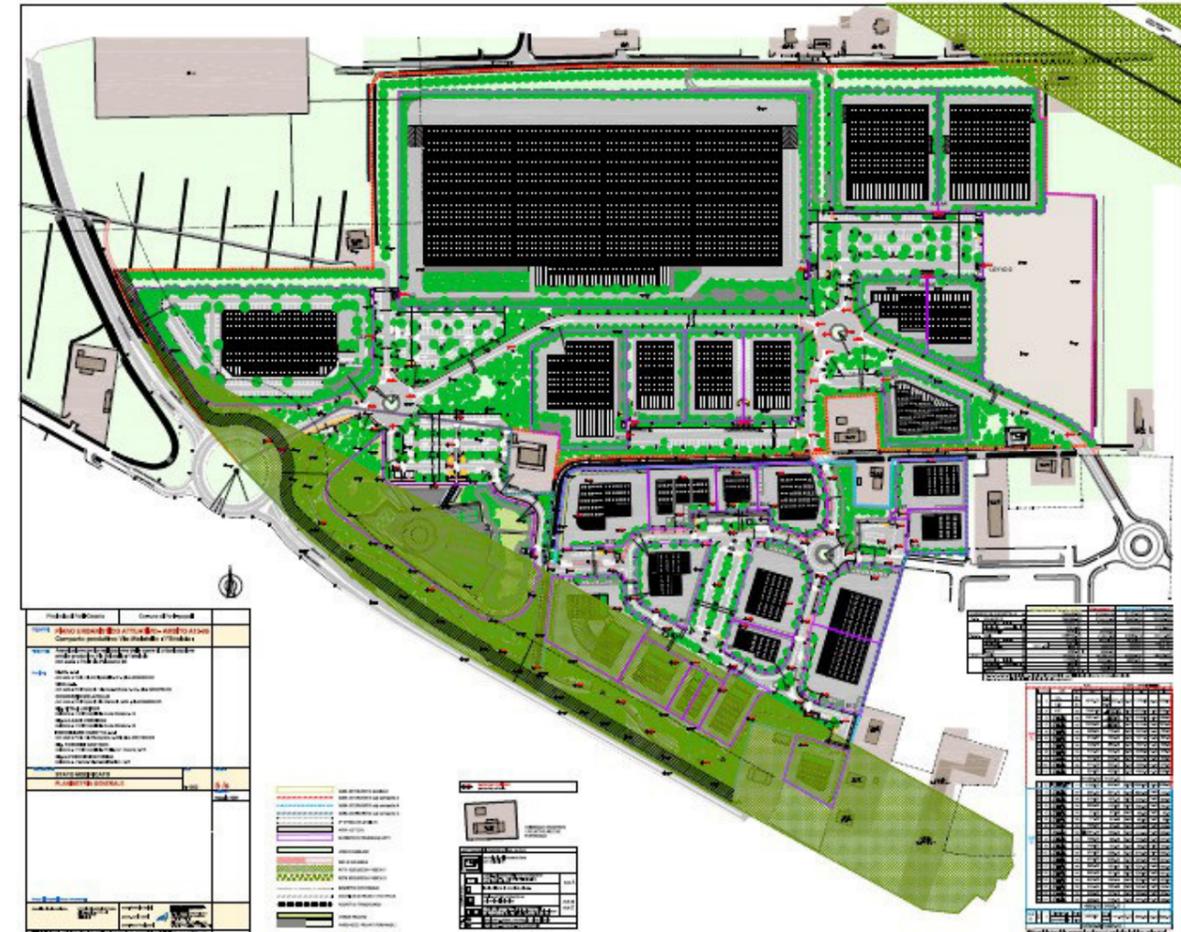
I POC- Tavola PUA A13-06 - Stralcio planimetria generale PUA
